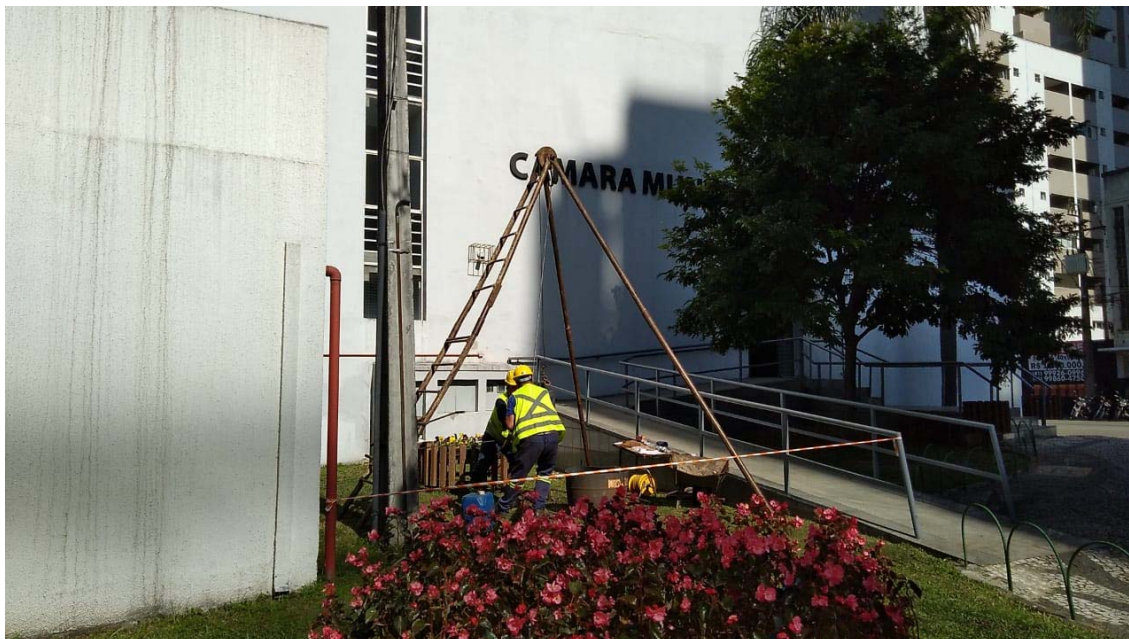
Perfuração do furo SP-02. Foto Alexandre.
